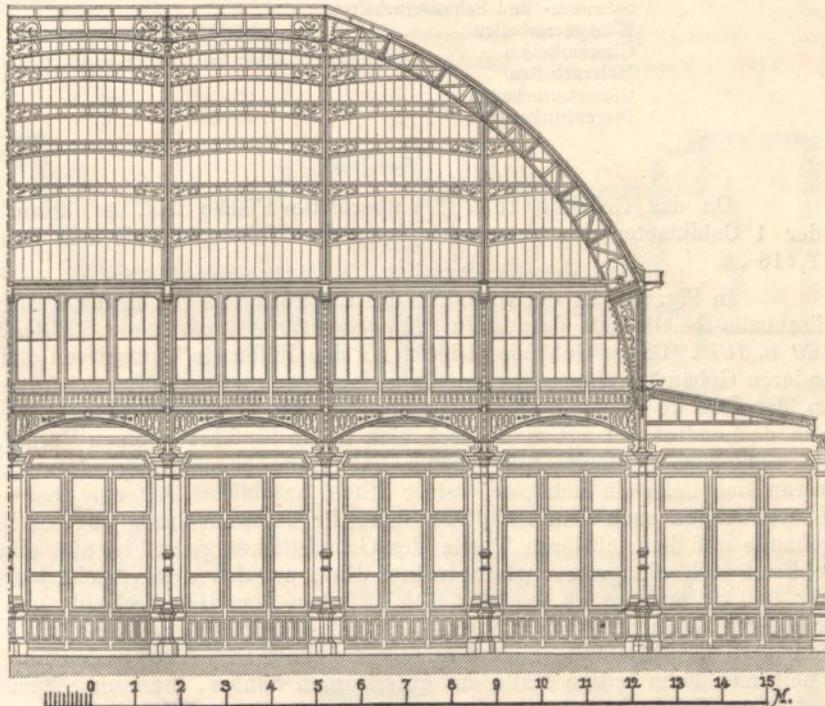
Glasbedeckter Hof und Halle. Längendurchschnitt (Architekt L. Renaud).
